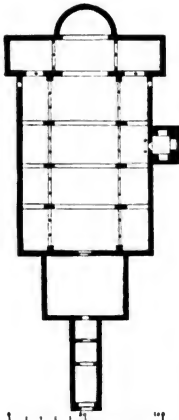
Rom: S. Prassede, Grundriss.
